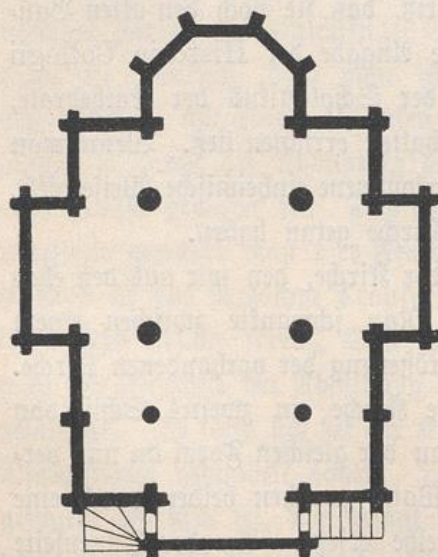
Löwen. Grundriß für eine Kollegskirche.
